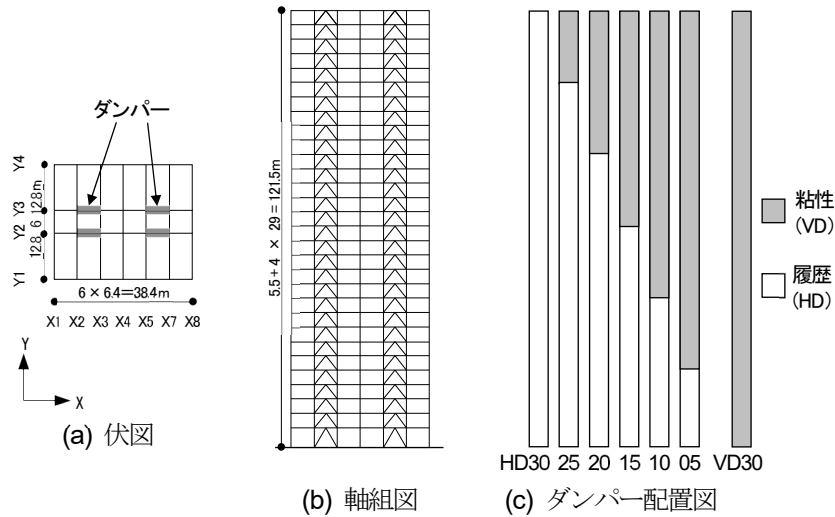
対象制振建物の伏図，軸組図，ダンパー配置図
